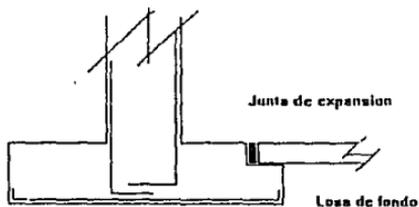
3. Union de pared sobre zapata con losa de fondo no estructural.
